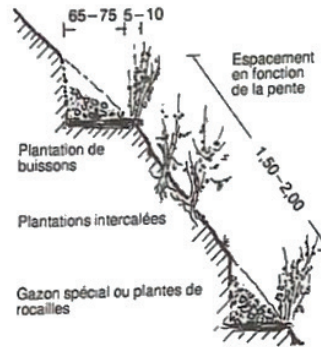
Plantation de buissons, plantation pionnier et gazon spécial pour la consolidation du talus.
